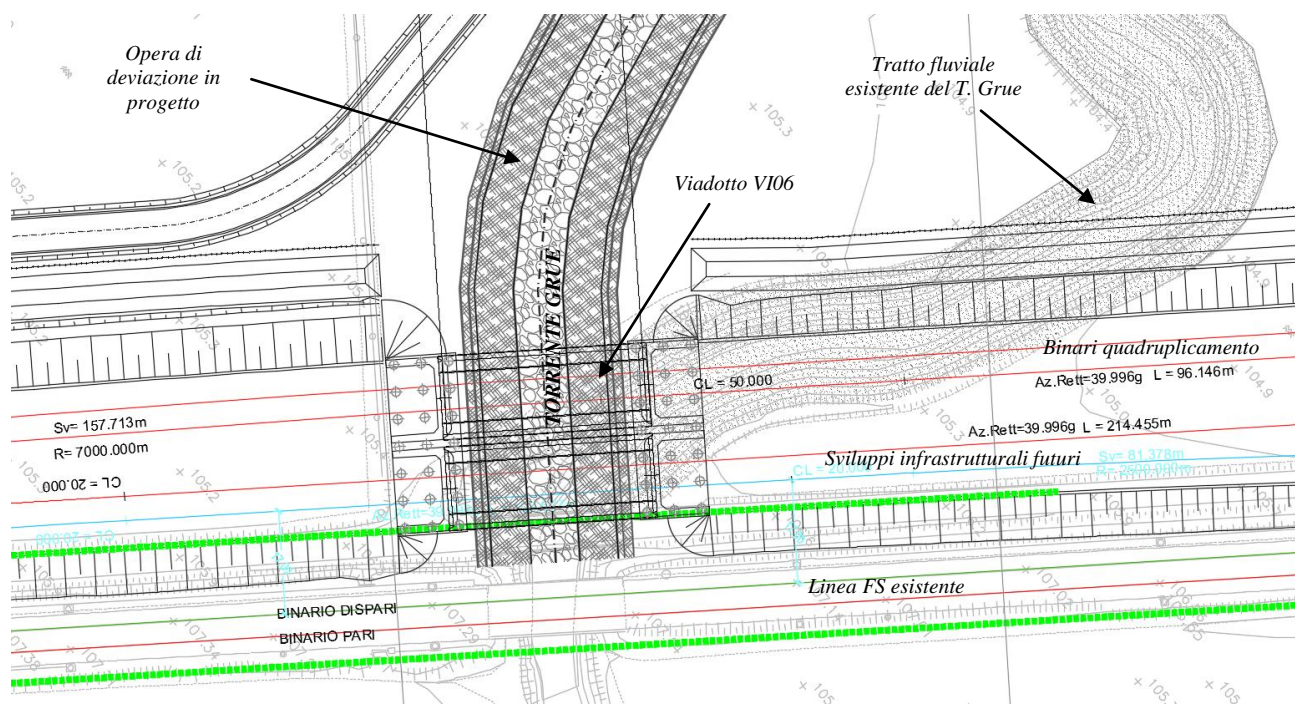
Torrente Grue: pianta dell'opera di attraversamento in progetto
